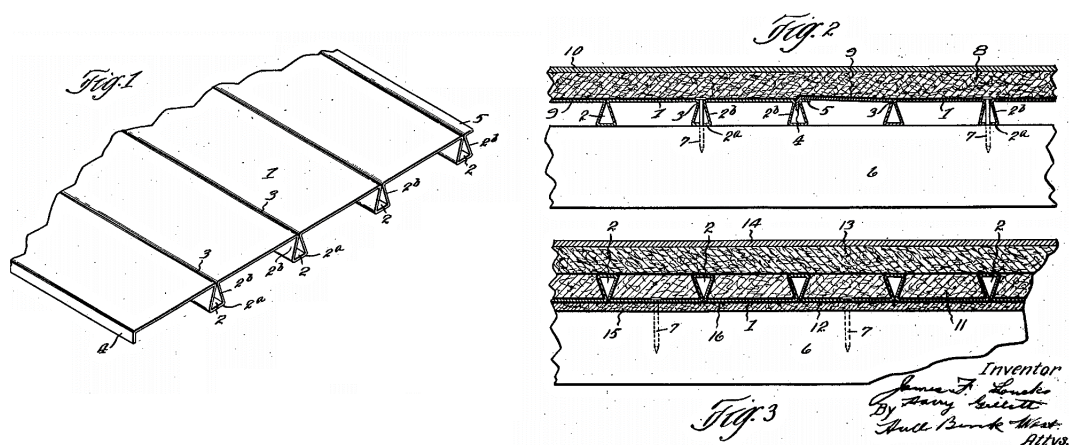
Pavimento com chapa metálica por J. Loucks e H. Gillette, 1926 (Sputo, 2012).
